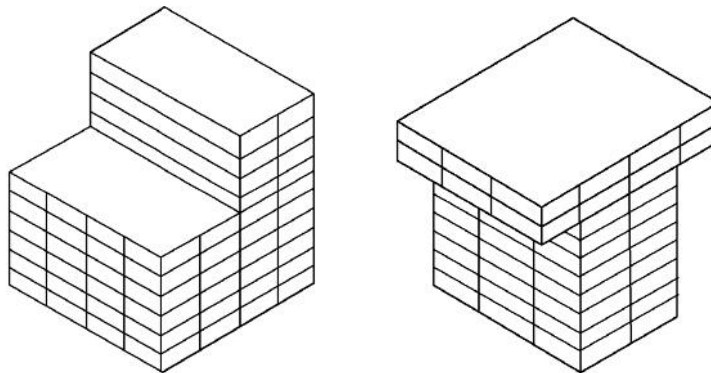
Ejemplos de cambios bruscos de áreas de planta en entrepisos contiguos que llevan a estructuras irregulares en elevación (Arnold y Reitherman, 1986).
